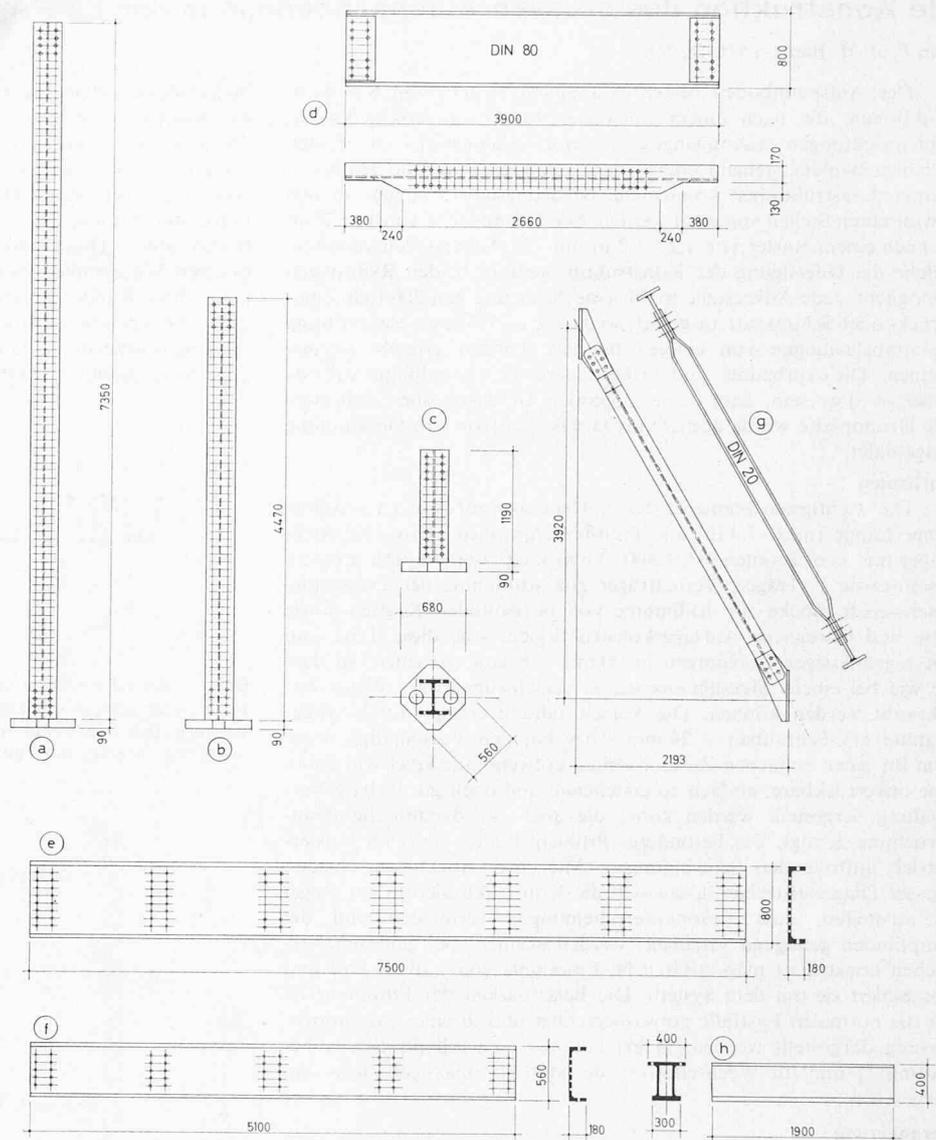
Aufbauten-Einzelteile, Masstab 1:80. Die wichtigsten Einzelteile, aus denen Aufbauten zusammengesetzt werden können: a)b)c): Stützen aus HEB 360; d): Jochträger aus HEB 800; e): grosser U-Träger, geschweisst; f): leichter U-Träger, geschweisst; g): Streben; h): Verteilsträger
